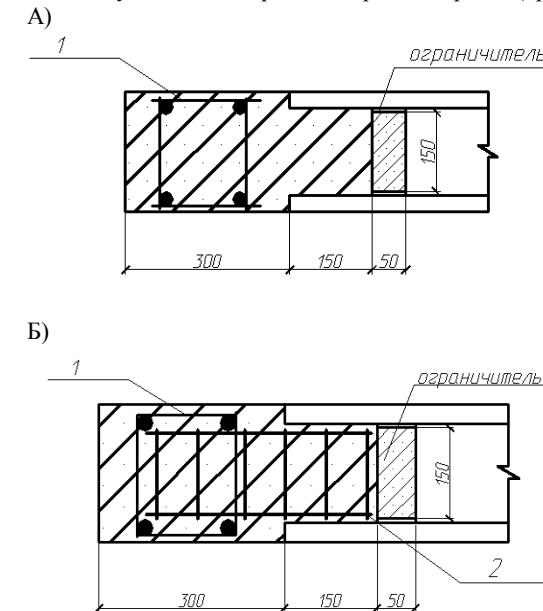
Узлы опирания плит перекрытия на ригель с применением шпонок.
